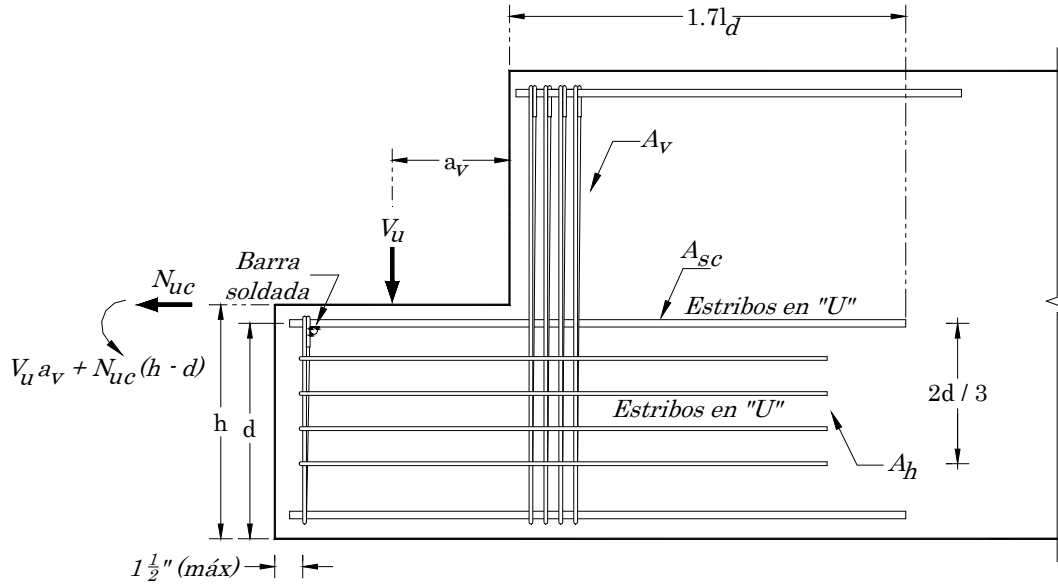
Detalles de refuerzo en una ménsula de concreto reforzado
